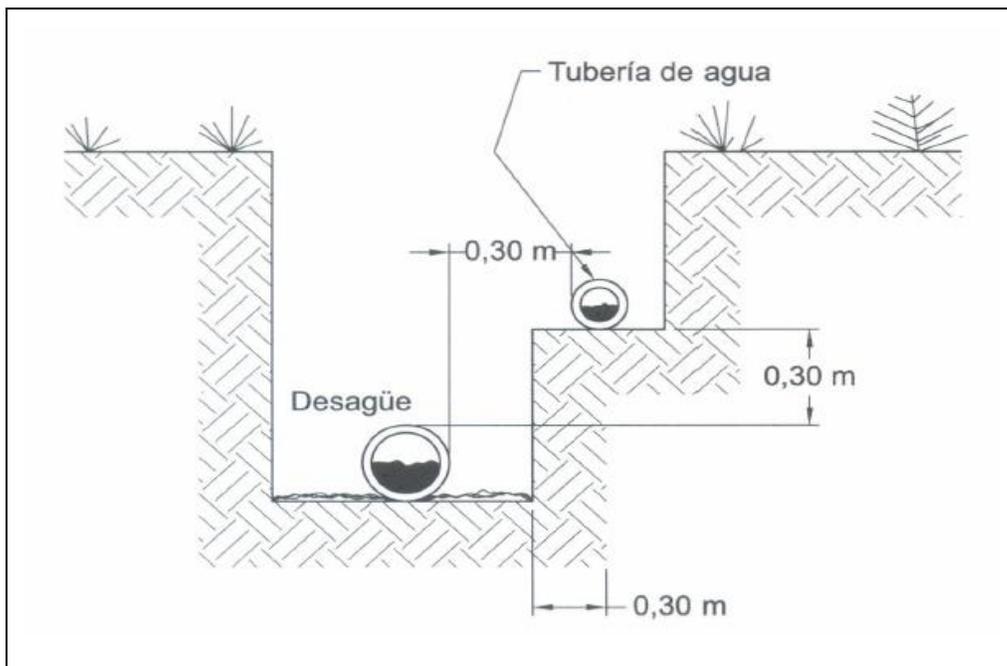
Separación mínima entre la tubería de desagüe y la tubería de suministro de agua.
